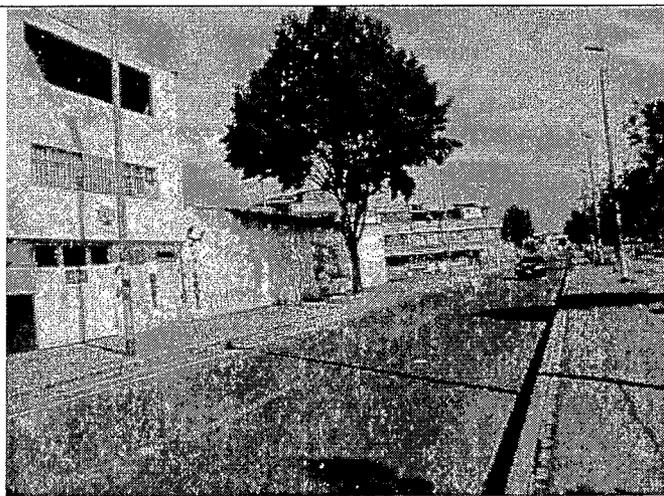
Vista de la vía de acceso en sentido Sur – Oeste, Dg 71Bis
